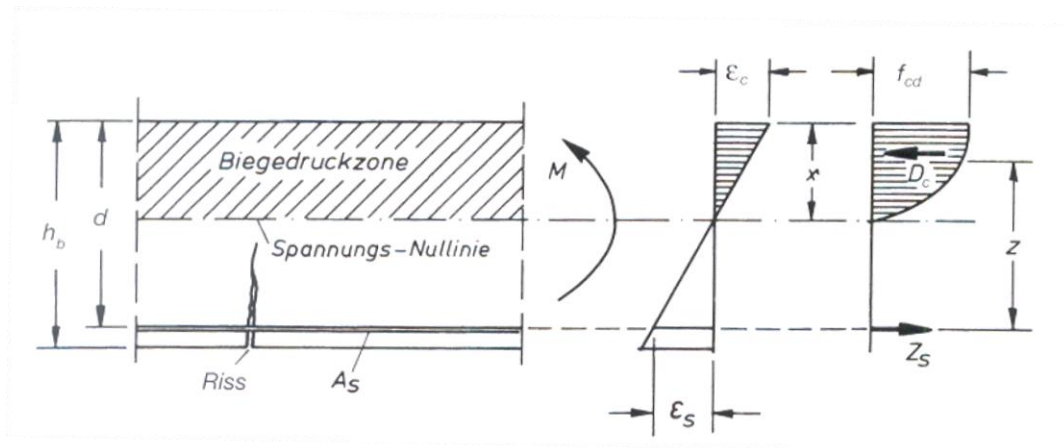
Biegerisse in einem Betonquerschnitt [5]
